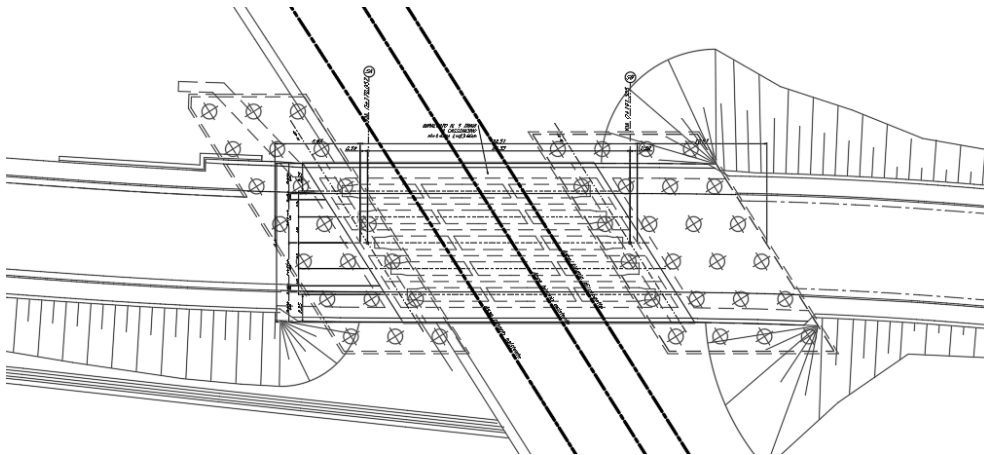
Stralcio planimetrico – ubicazione opera d'arte
